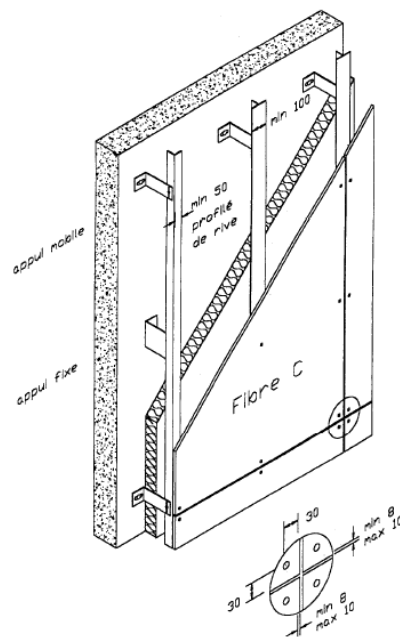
Estrutura de apoio secundária para sistema de fixação visível
